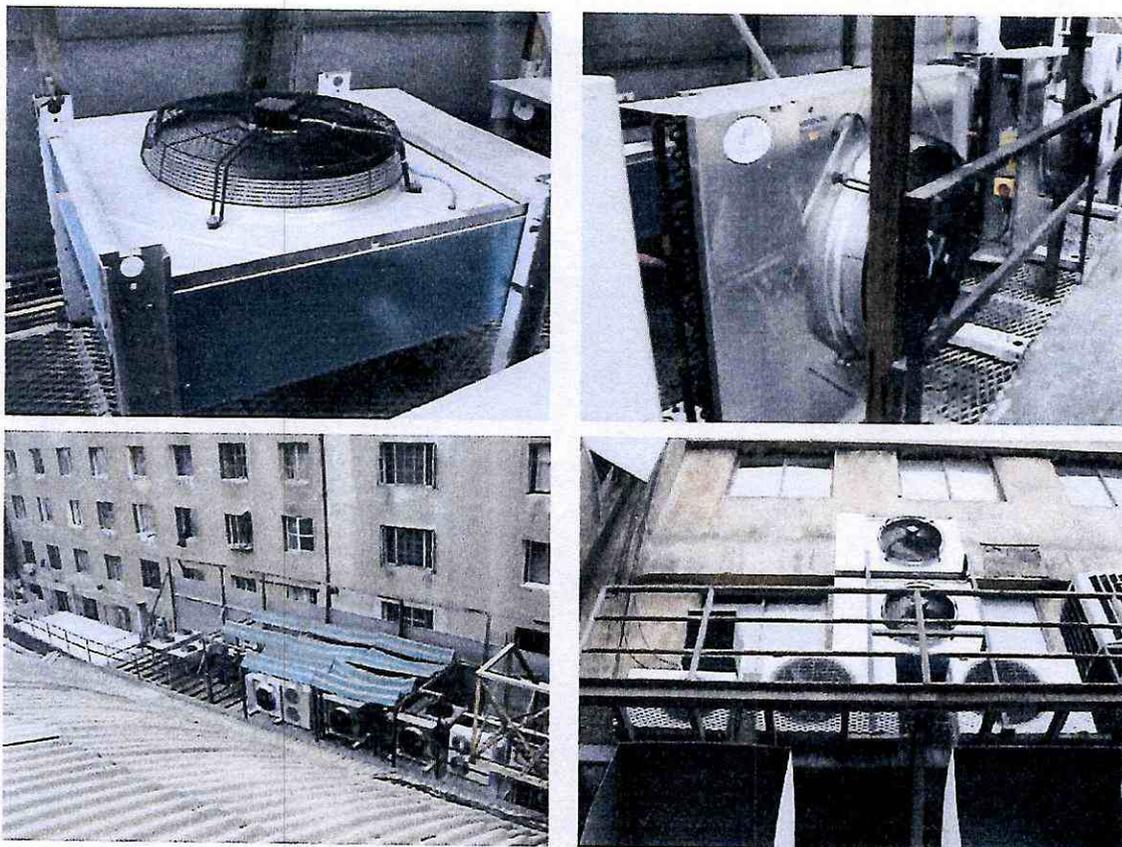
Equipos ubicados en cubierta y fachada norte del edificio de GTD.
